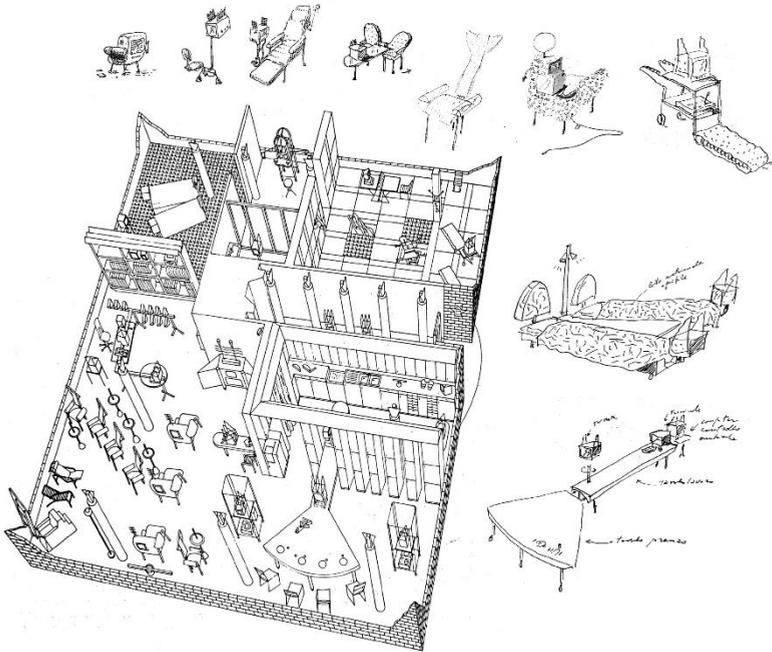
Casa Telemática, Ugo La Pietra, Feria Internacional de Milán (1983).
